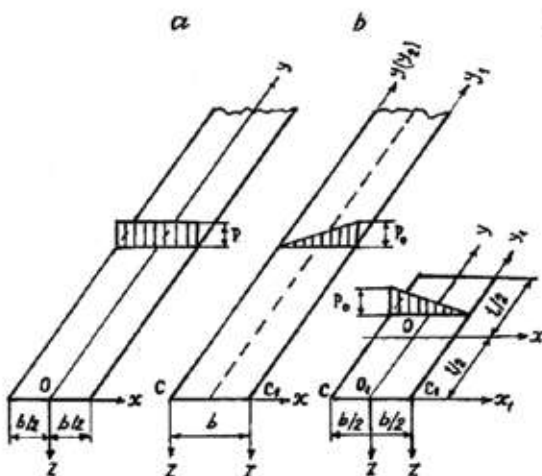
Схемы нагружения ленточного (полоса) и прямоугольного фундаментов: а и б- полоса полубесконечной длины; с - прямоугольный фундамент.
